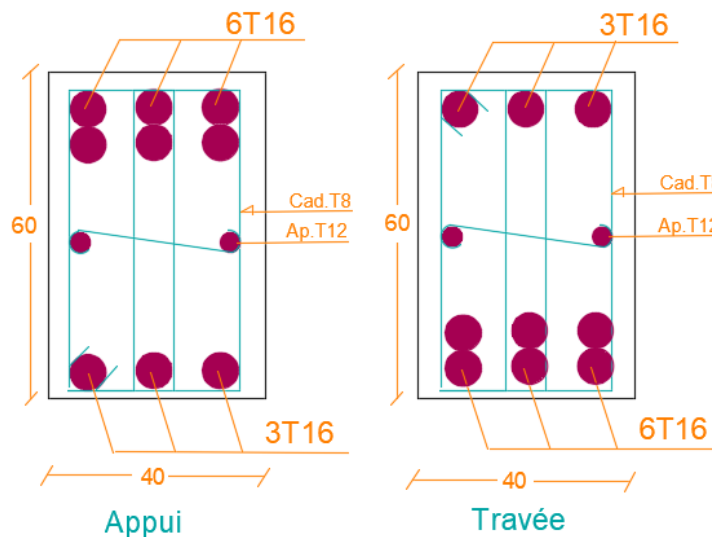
Ferrailage Des Poutres Porteuses Axes (A-B-E) Du Niveau Terrasse.
